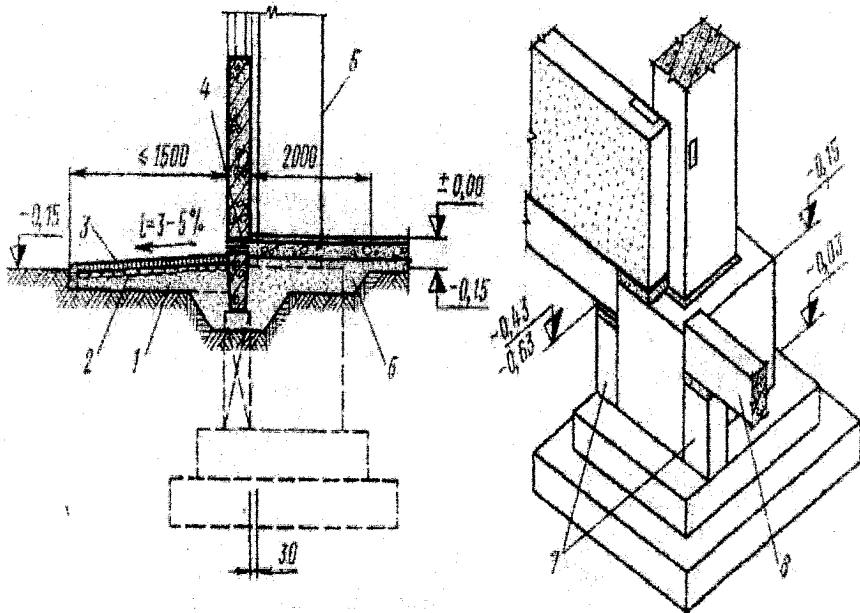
Деталі фундаментів крайнього ряду колон:
